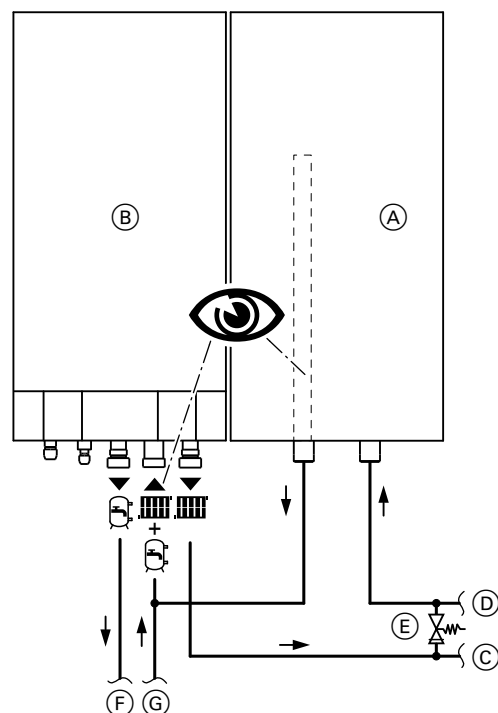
Podłączenie w przypadku zasobnika buforowego wody grzewczej wiszącego z lewej i prawej strony
